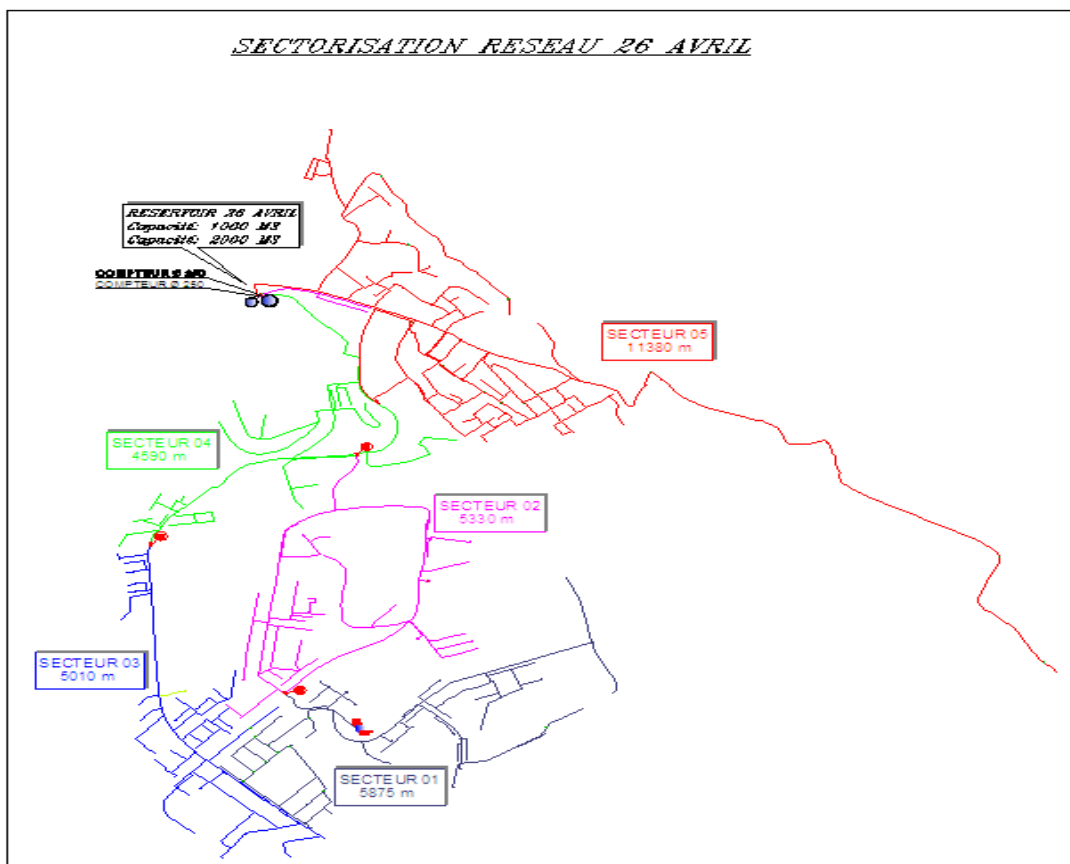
Plan de sectorisation du secteur 26 Avril
